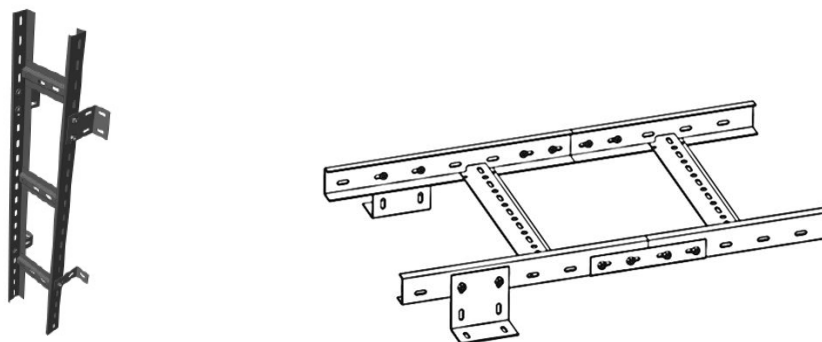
Пример монтажа лестничного лотка при помощи уголка монтажного опорного
